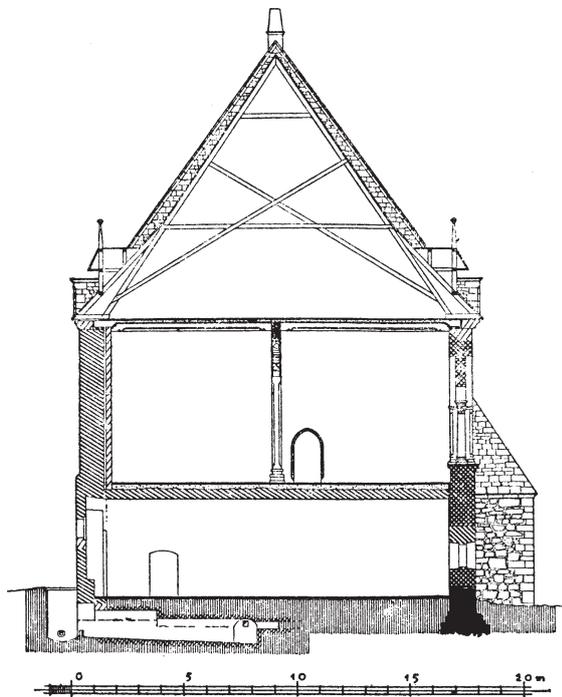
Pfalz Goslar. Längsschnitt durch die nördliche Hälfte des Saalbaus (»Kaiserhaus«) mit den Heizungsanlagen unter dem Kellergeschoss. – (Nach Hölscher 1927, Taf. 22 oben).
